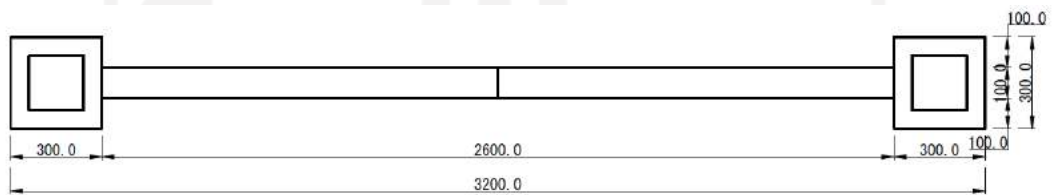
Benda Uji Balok Polos Tampak Depan
